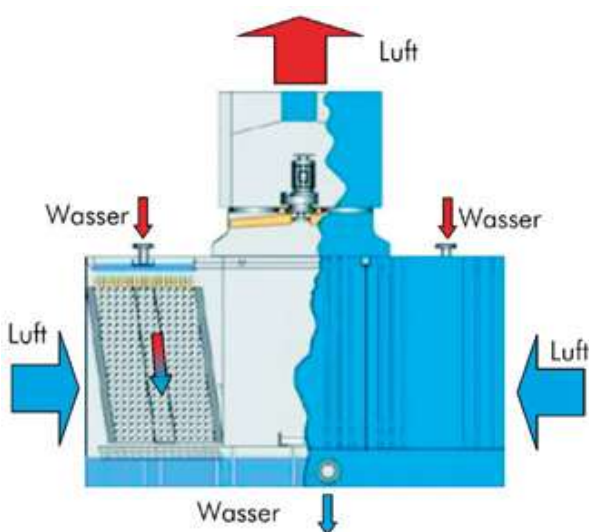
Saugbelüfteter Verdunstungskühlturm für offenen Kreislauf mit Axialventilator mit Kreuzstrom Luft/Wasserführung (KTK Kühlturm Karlsruhe GmbH)
